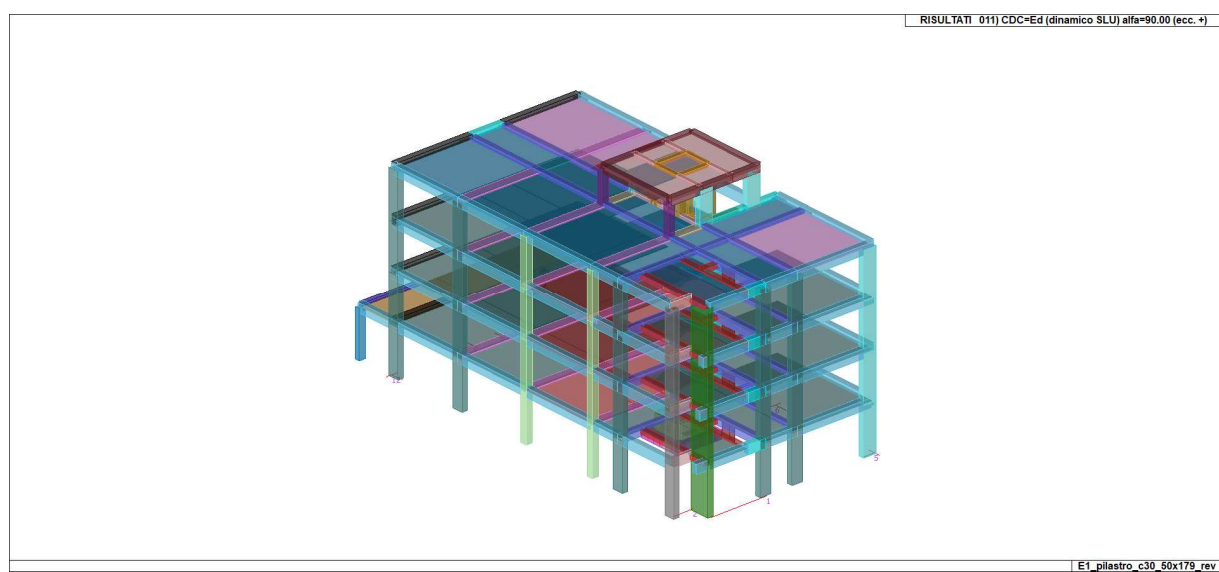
Vista assonometrica modello struttura in elevazione – comprensivo di solai
